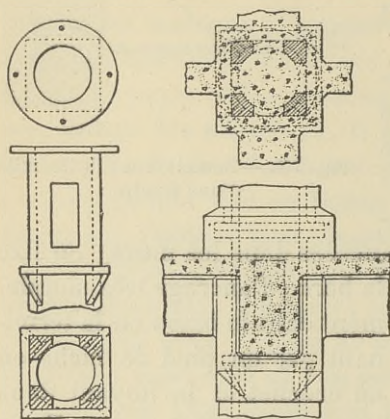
Poteau en acier coulé et plancher en béton armé.
